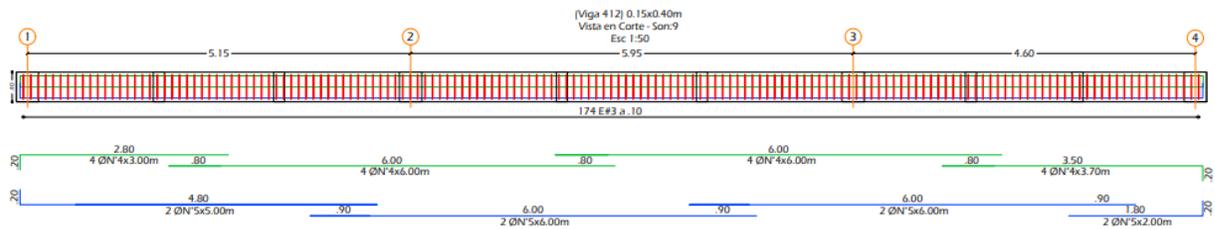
Despiece de viga secundaria 412 plano estructural Wiedii
